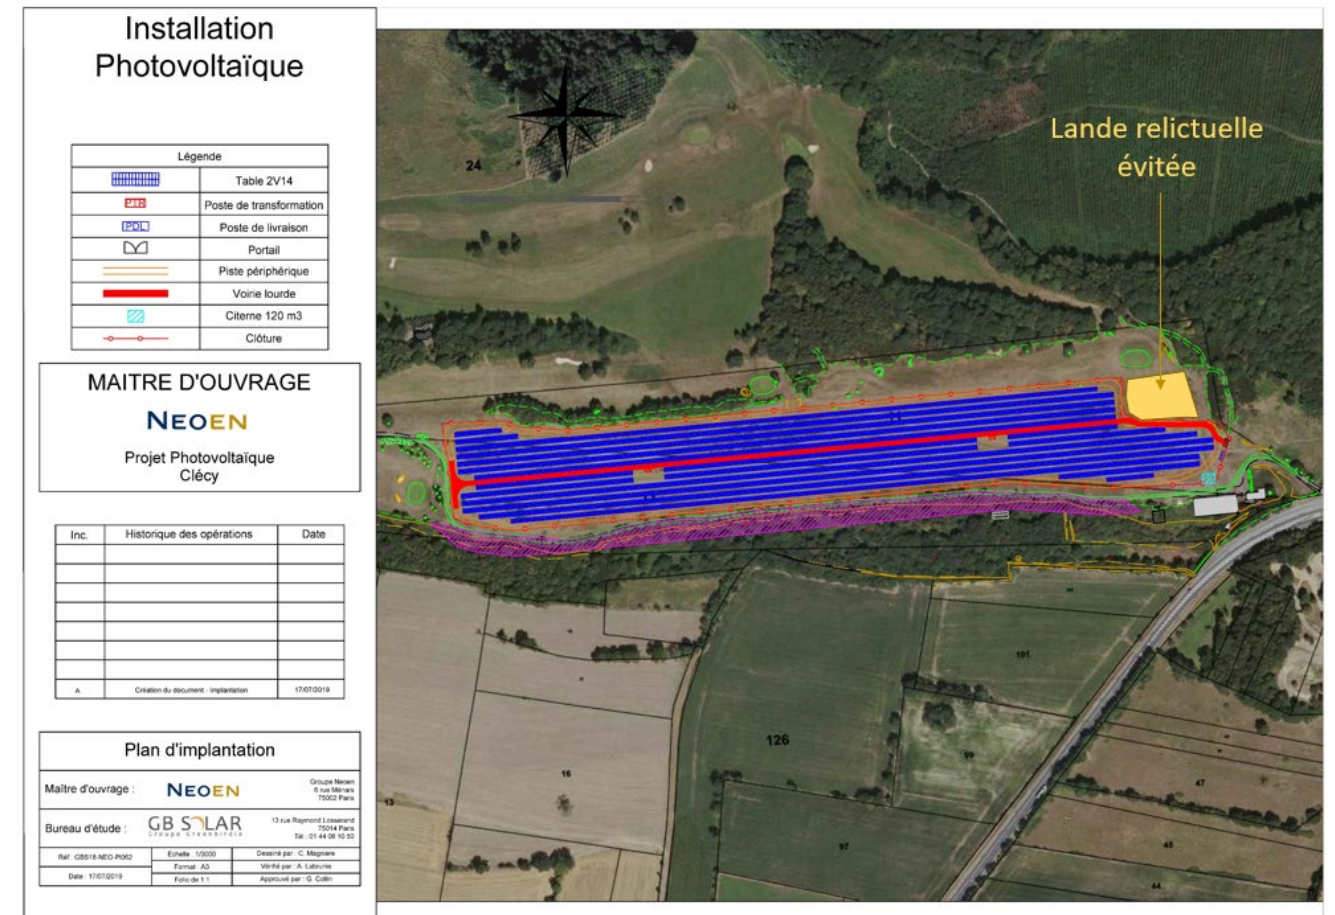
Plan d'implantation préservant la lande sèche relictuelle
